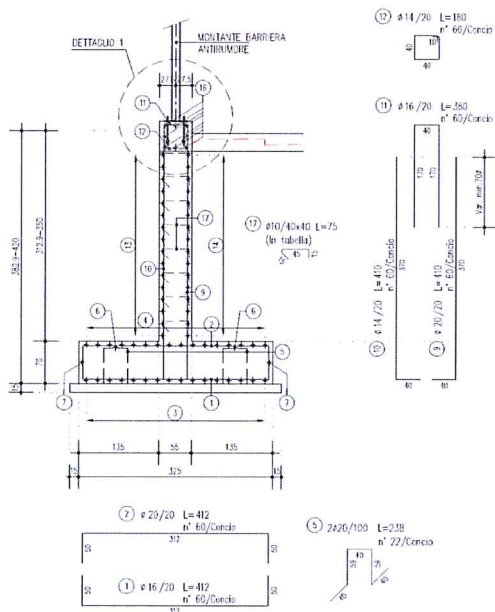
Schema armatura – Muro tipo 4 –Concio 24 e da 26-41
